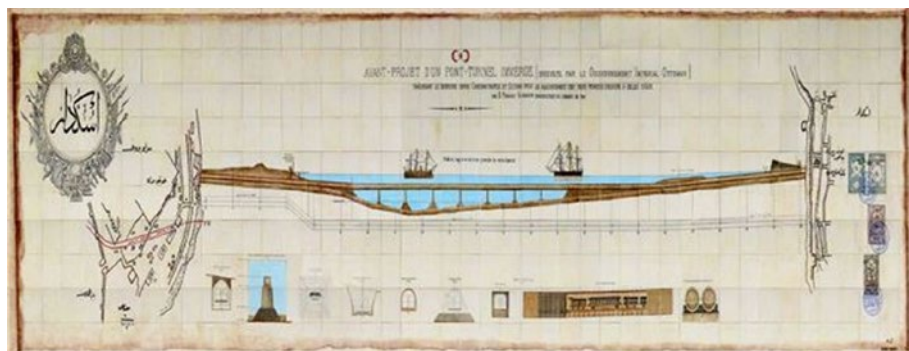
Planos del anteproyecto de la época otomana de *Pont-tunnel immergé*. Un túnel apoyado sobre pilotes por el que el tren cruzaría el Bósforo en la zona de Estambul, 1902. Arriba, la sección del terreno por el Bósforo y, abajo, las secciones transversales y longitudinales del túnel [11]
